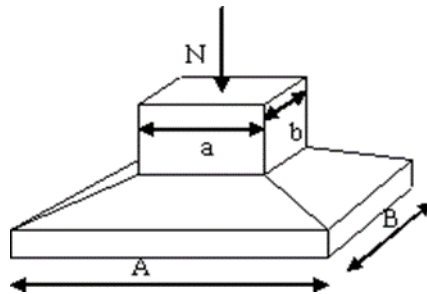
Schéma de principe d'une semelle isolée
